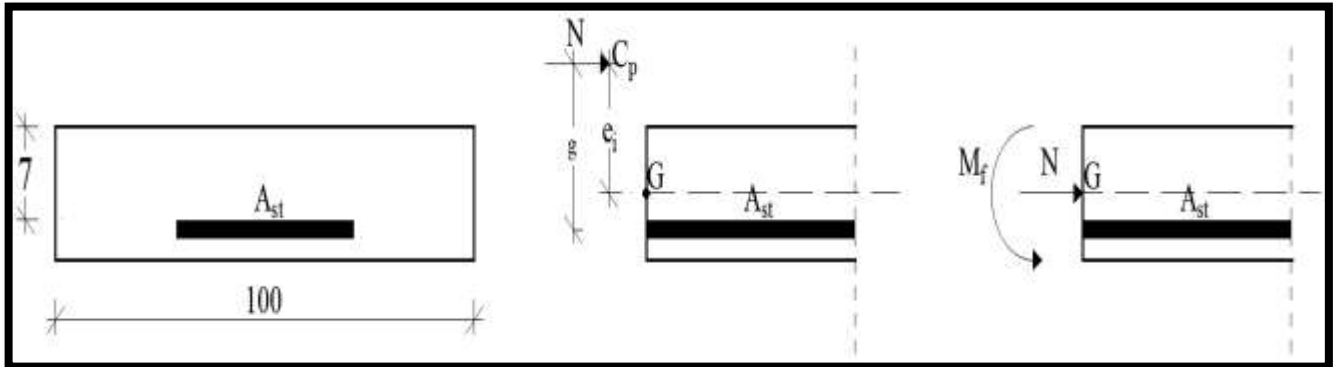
Schéma de la section du calcul de l'acrotère
